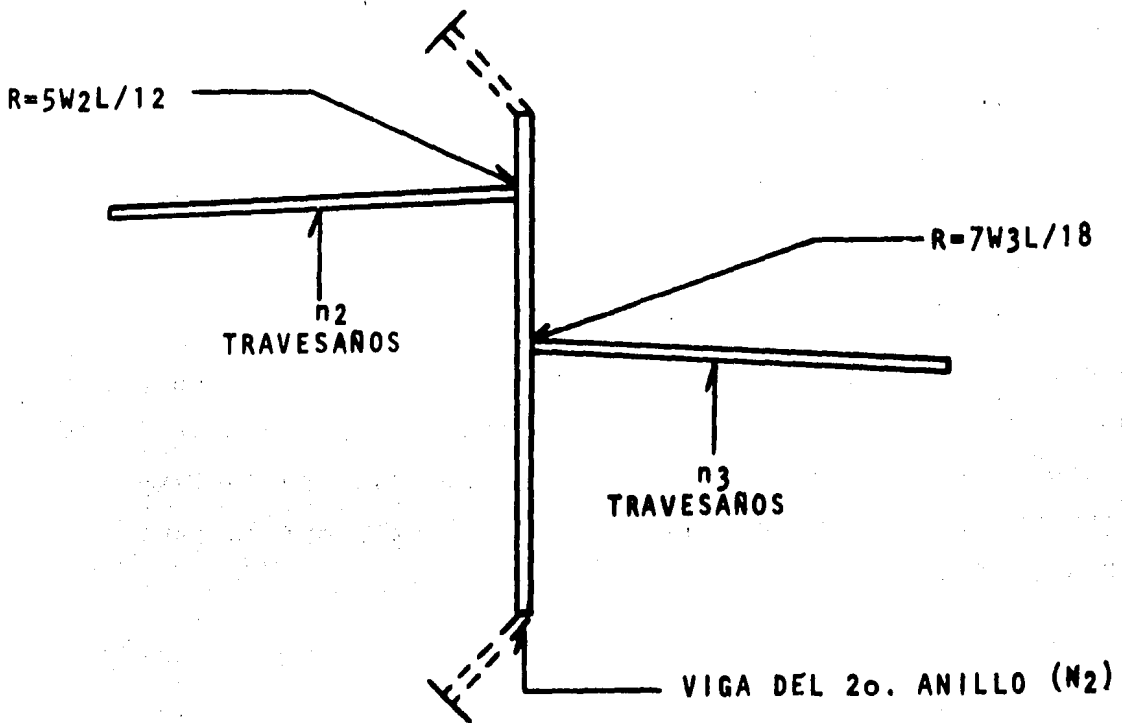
DISPOSICION DE LAS VIGAS DEL SEGUNDO POLIGONO.
